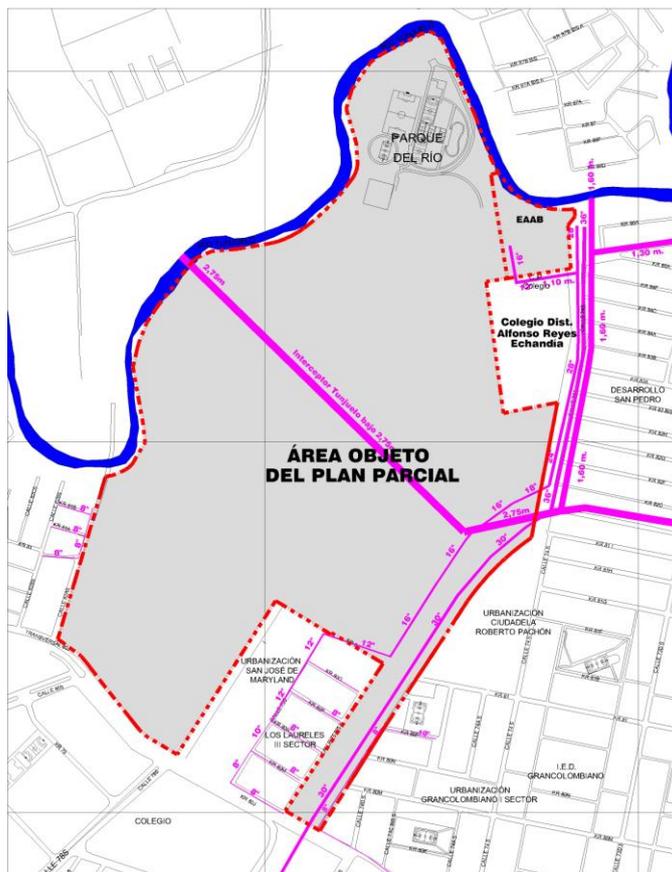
Estructura de servicios públicos - Redes de Alcantarillado Sanitario
